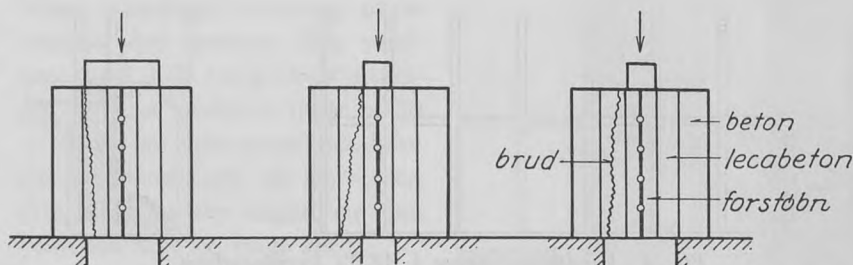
Statsprøveanstaltens arrangement til prøvning af forskydningsstyrken i facadeflisernes Lecabeton.
